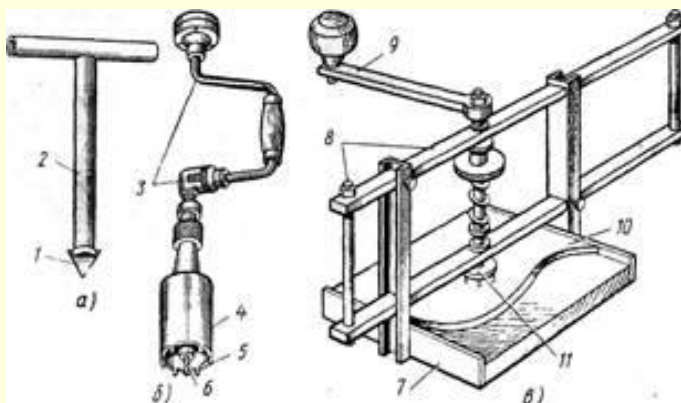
Інструменти і пристосування для свердлення отворів в керамічних плитках: а - розгортка, би - коловорот з приставкою, в - пристосування для свердлення; 1 - наконечник з твердого сплаву, 2 - корпус з ручкою, 3 - коловорот, 4 – приставка 5-різці з твердого сплаву, 6-центральне свердло, 7-підстава, 8-рама, 9 - ручка різця, 10 - плитка, 11-різець
